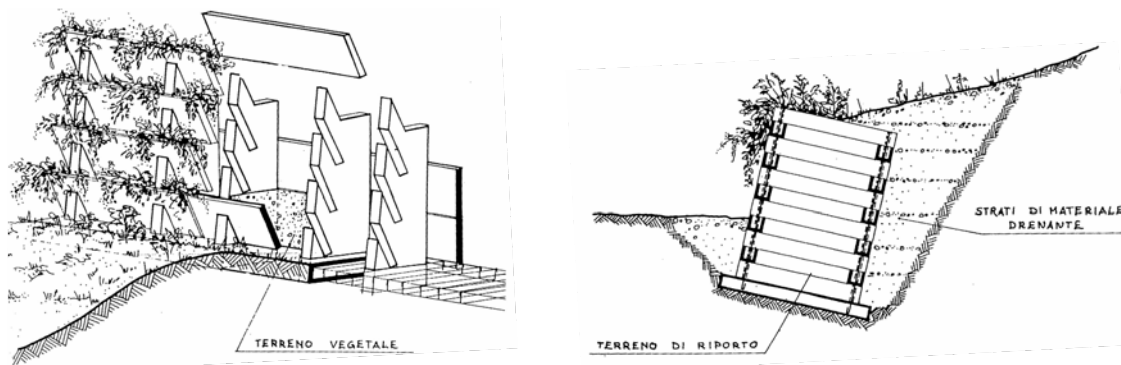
Rappresentazioni schematiche di differenti tipologie di muri cellulari: a sinistra muro con elementi planari (pannelli) in calcestruzzo disposti in maniera tale da formare una sorta di scaffalatura riempita con terreno vegetale; a destra sezione tipo di un muro cellulare in travi di calcestruzzo (da REGIONE EMILIA ROMAGNA, 1993) -
